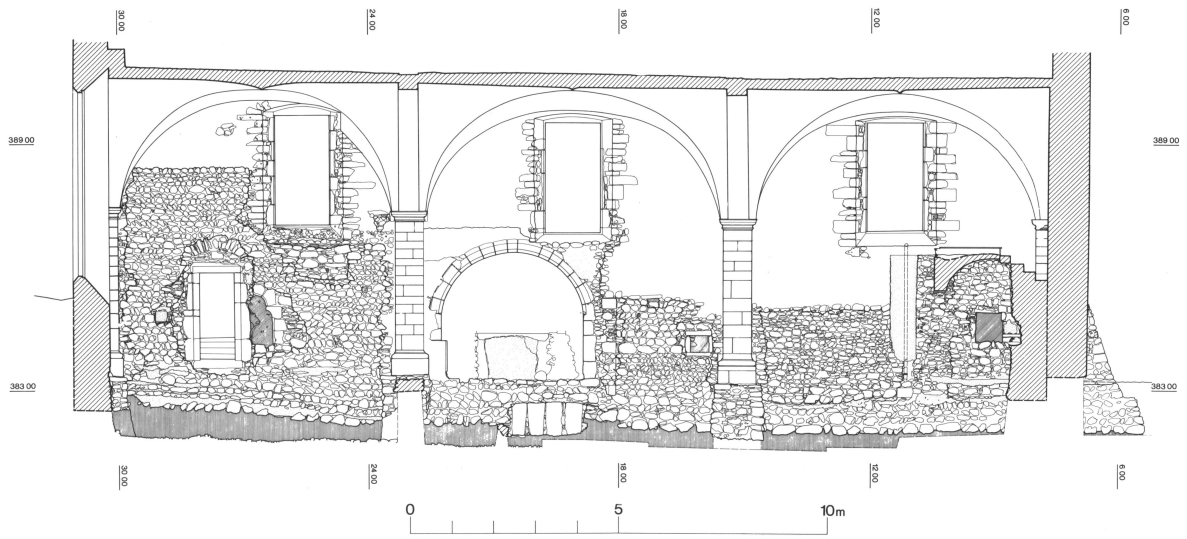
Elévation intérieure du mur sud. Echelle 1:100.
